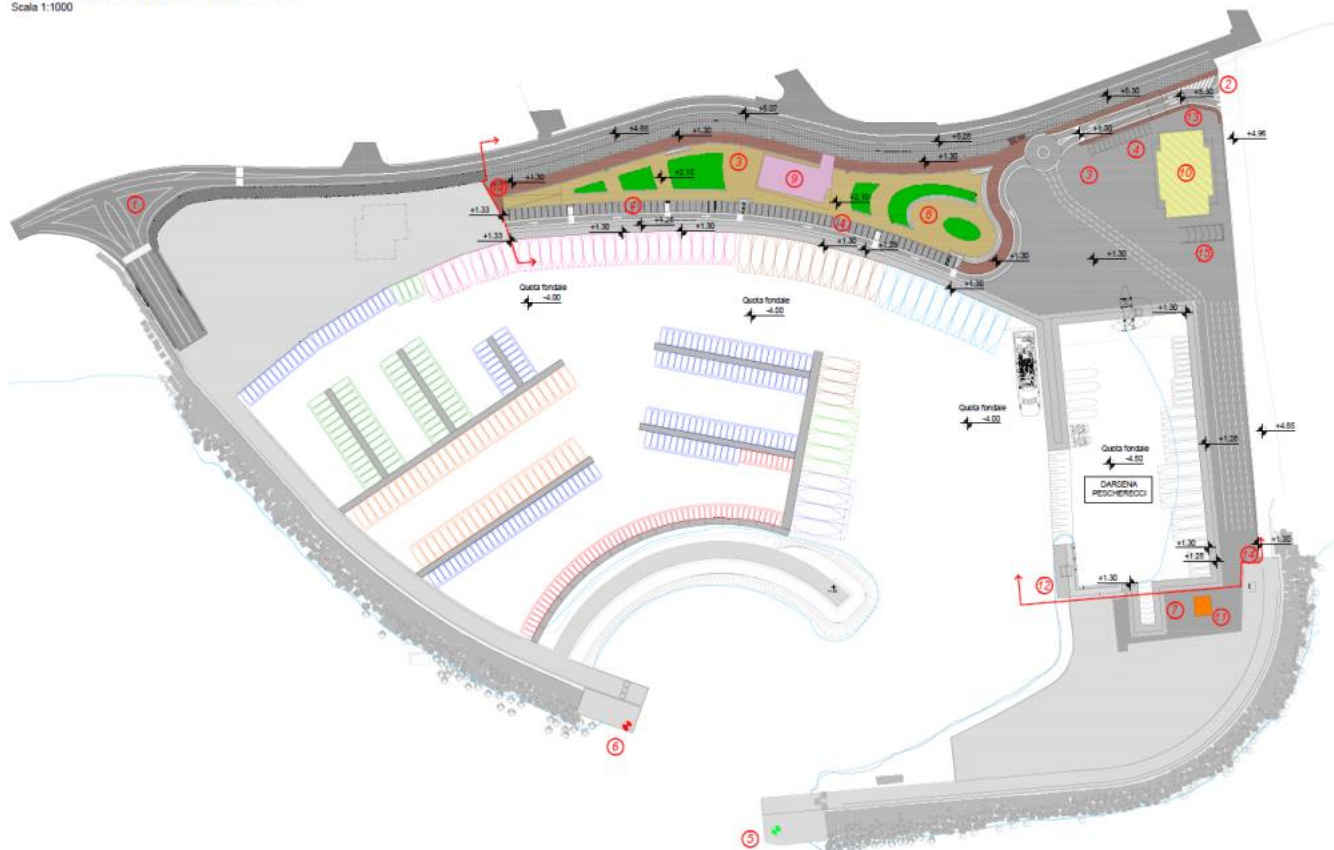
Estratto della tavola B10 – Planimetria generale di progetto
